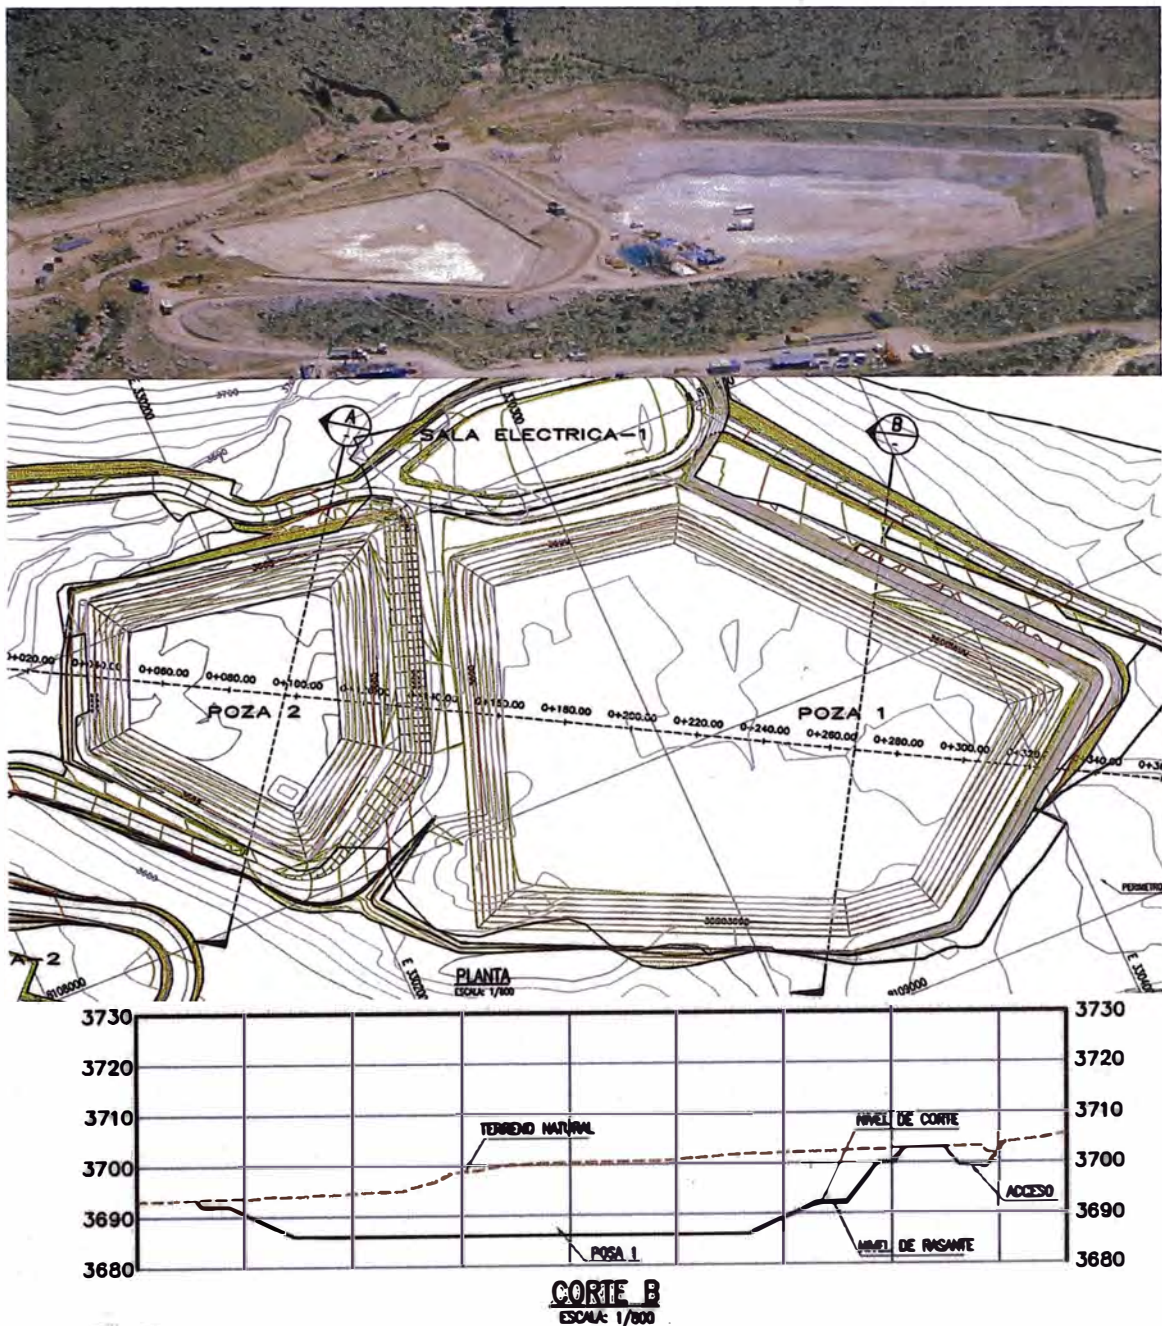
Planta de Pozas Q1 y Q2 – Sección Transversal
